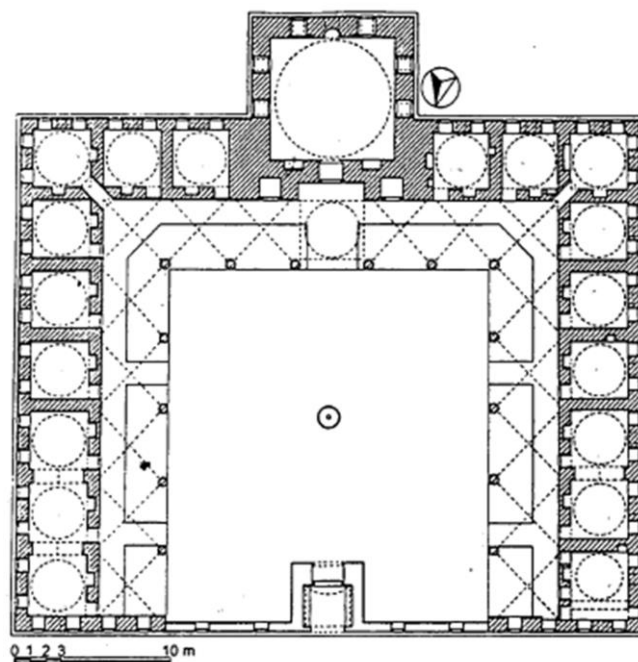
Vue en plan de la madrasa de Bayazid (Dundar, 2003)
